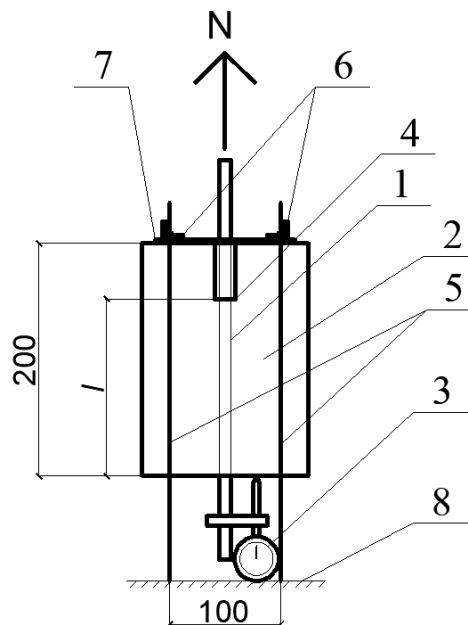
Схема випробування призмових зразків: 1 – арматура А500С; 2 – випробувальний зразок; 3 – мікроіндикатор; 4 – полімерний трубний ущільнювач; 5 – металеві шпильки $d = 12$ мм; 6 – металеві кутники; 7 – металева пластина; 8 – опорна плита.
